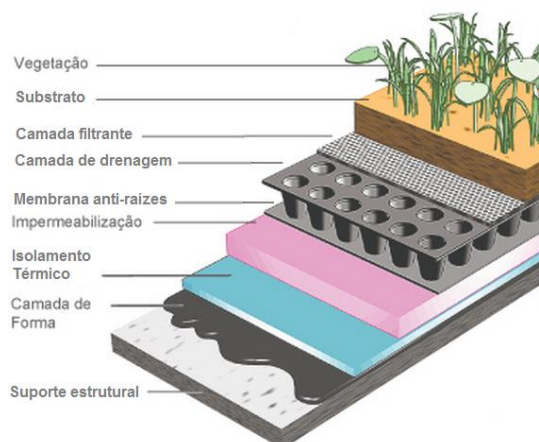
Sistema construtivo de uma cobertura verde (adaptado de Arq e Tec, 2014)
